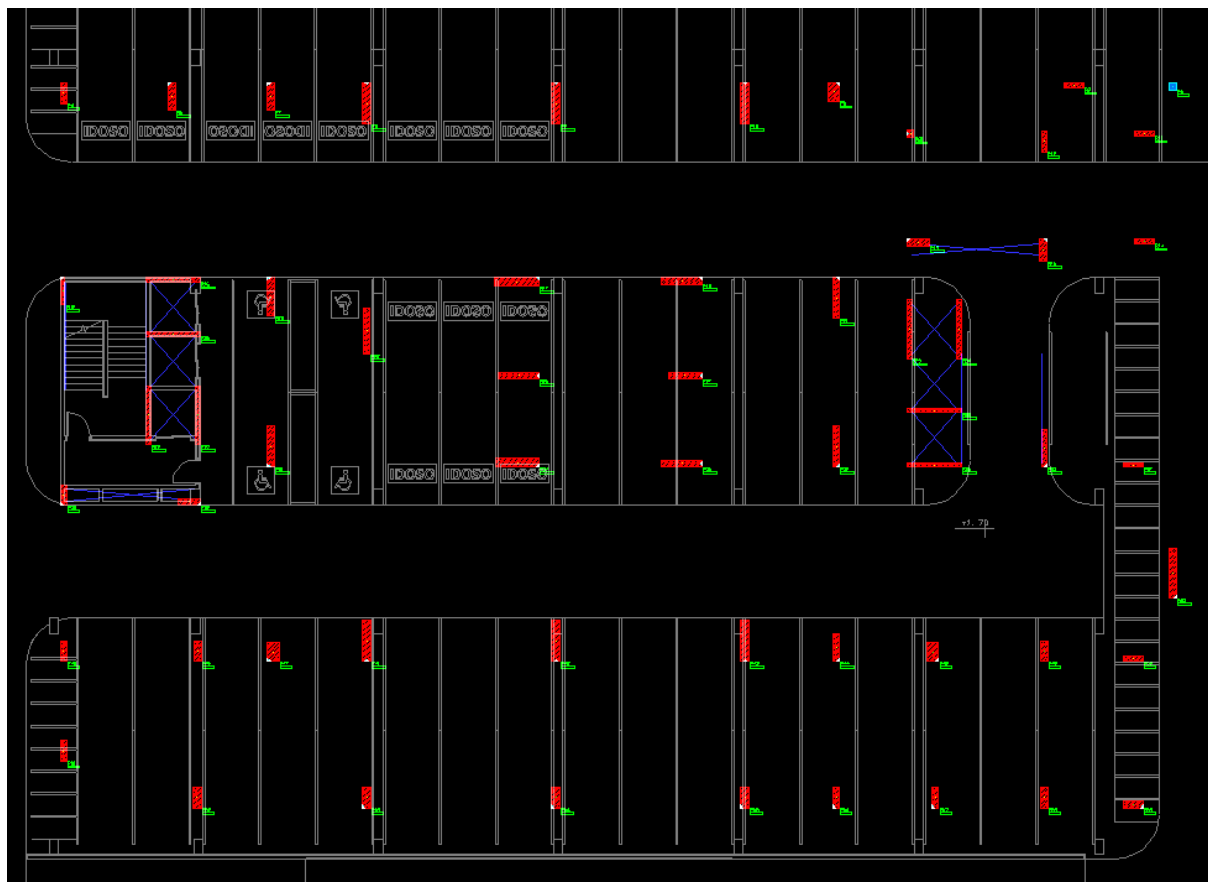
Projeção dos pilares no pavimento Térreo.
